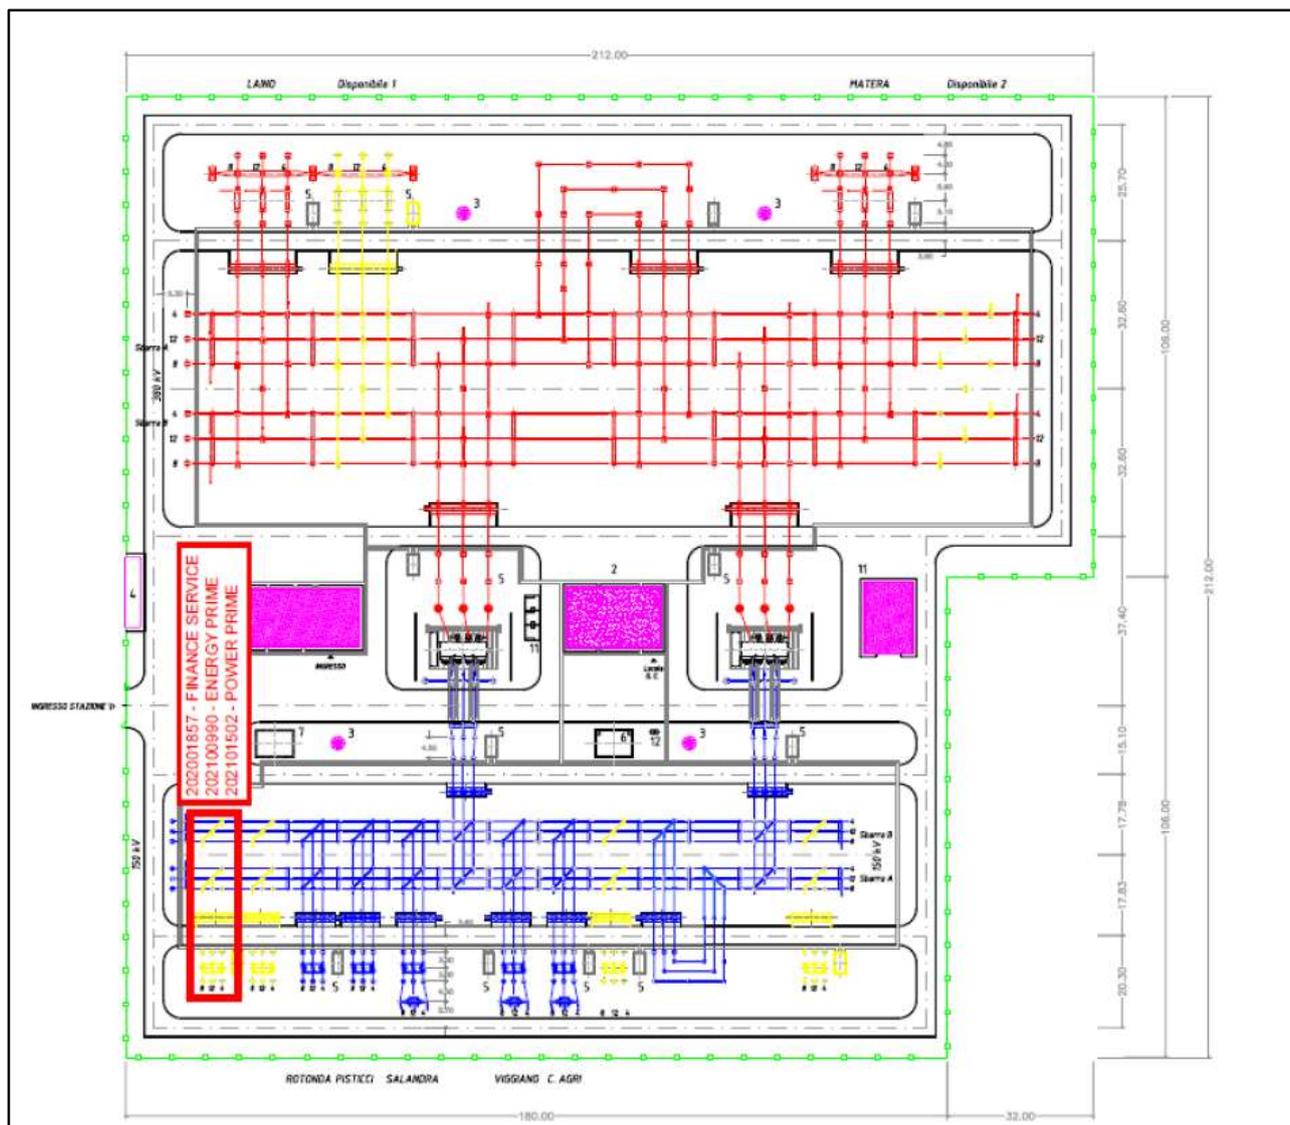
Planimetria della SE RTN a 380/150 kV con l'ubicazione dello stallo condiviso
